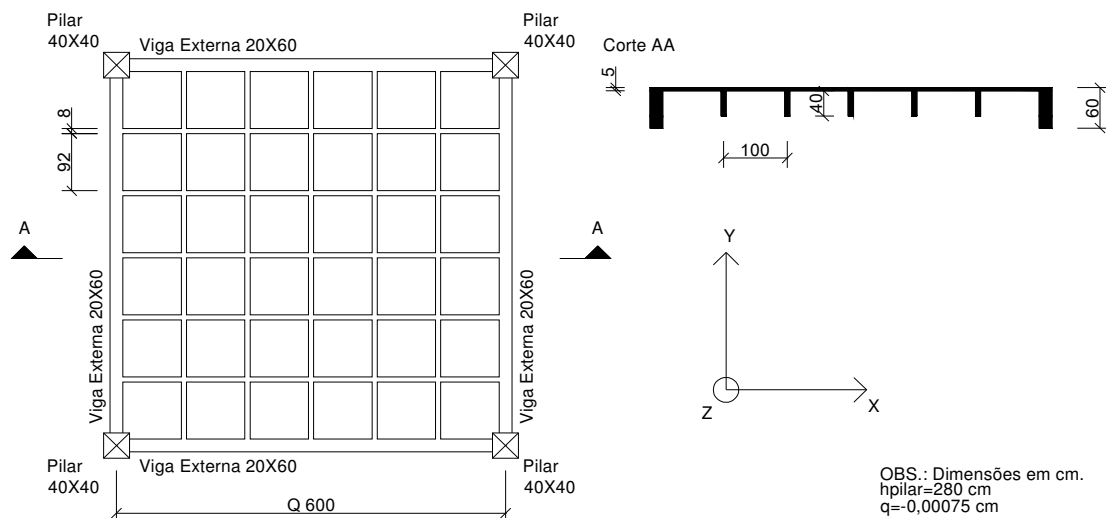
Desenho esquemático do pavimento 01 analisado n° de nervuras=5.
